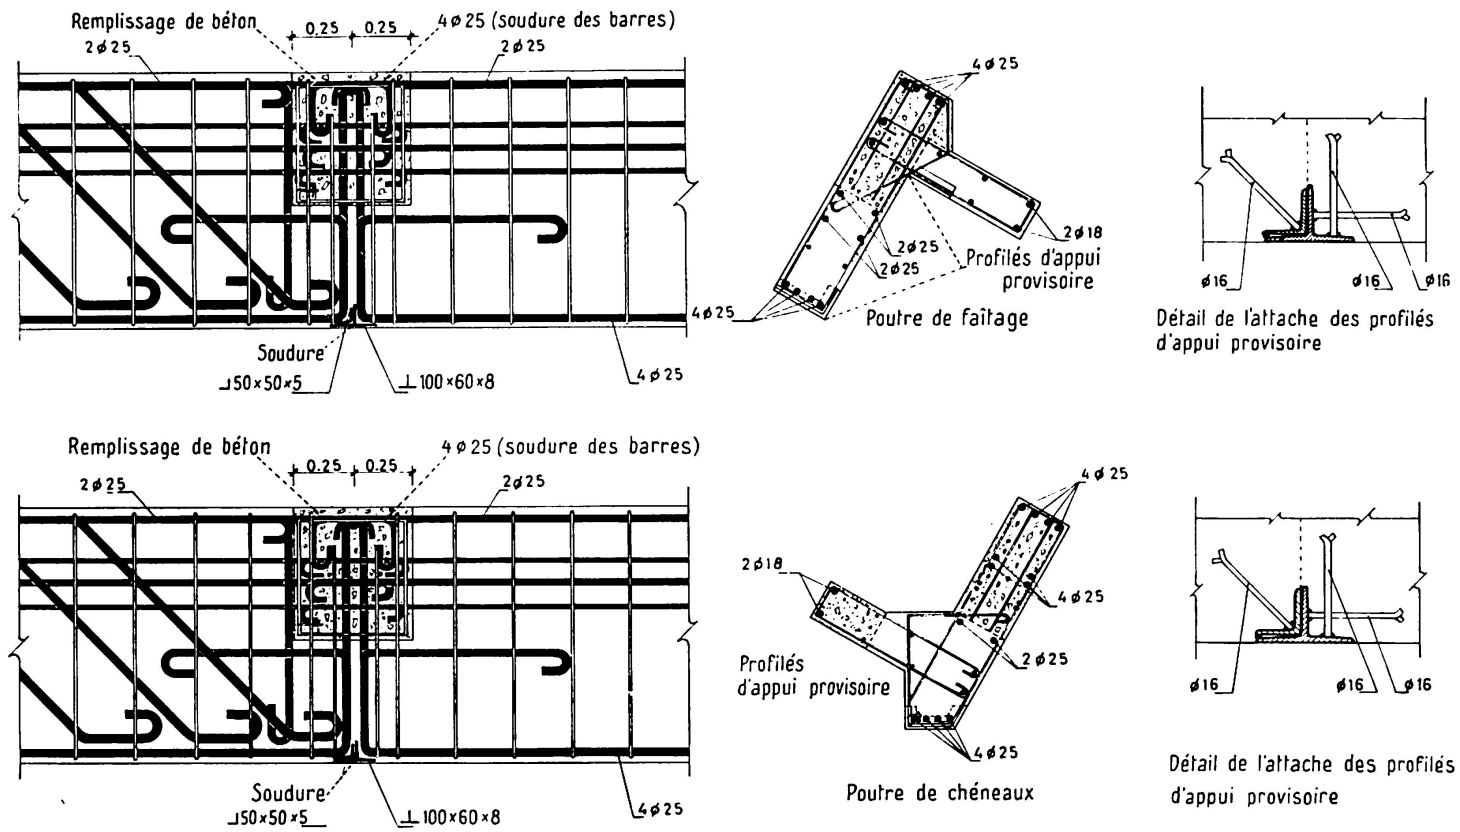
Assemblage des éléments d'une poutre préfabriquée *Atelier de Metalurgica Santa Ana (Linares)*.
